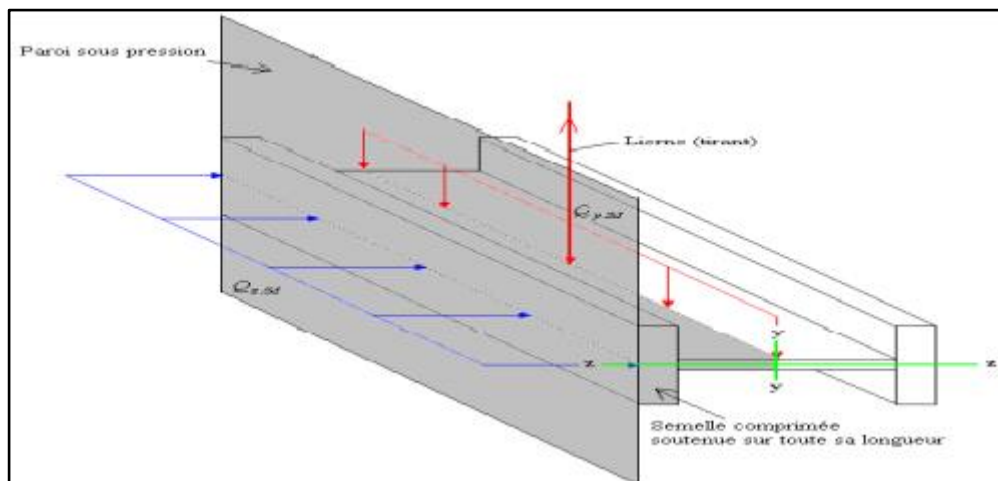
Semelle comprimée soutenue sur toute sa longueur.
